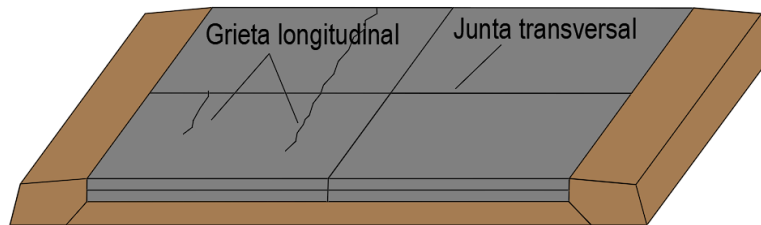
Esquema gráfico de fisura o grieta longitudinal
